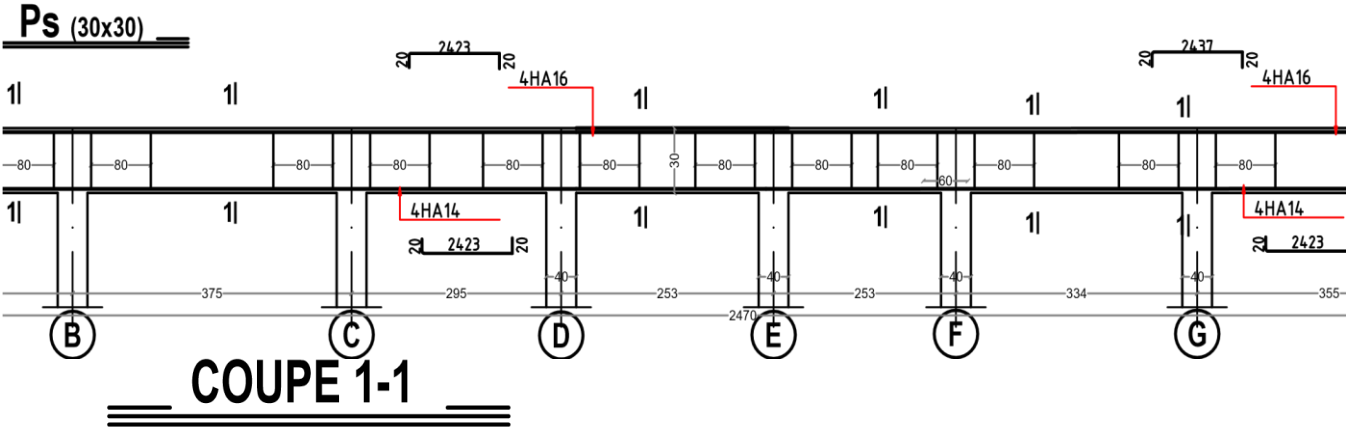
Ferrailage de la section transversale de la poutre secondaire.
